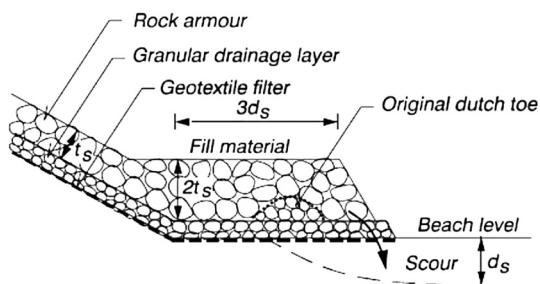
Protección del pie de estructuras en talud frente a la socavación mediante una berma de protección (McConnell 1998)
